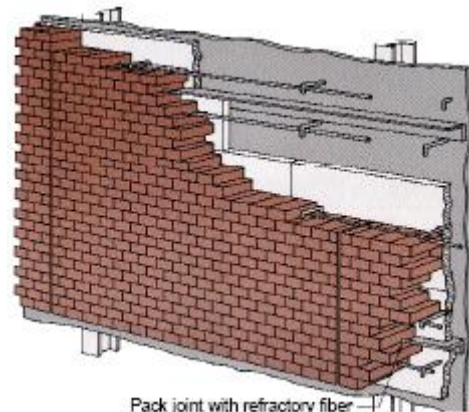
Construcción de pared soportada en secciones, diseño de anclaje de barra horizontal utilizando formas estándar.
